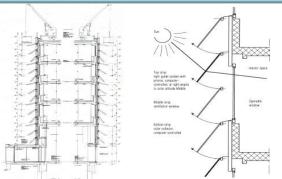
٣٢) قطاع و مسقط أفقي لمبنى سوفا (^{٢).}
